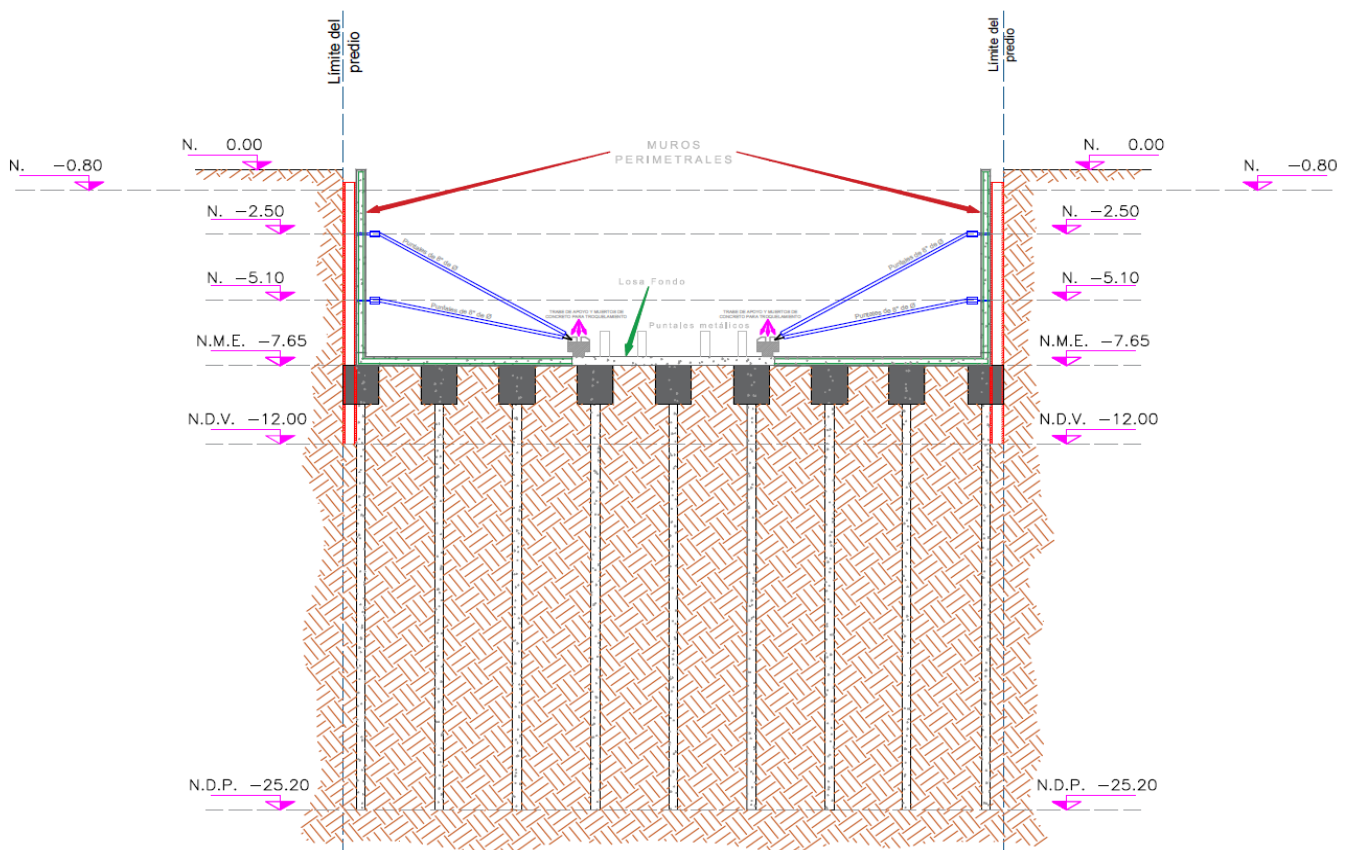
CONSTRUCCIÓN DE MUROS PERIMETRALES
